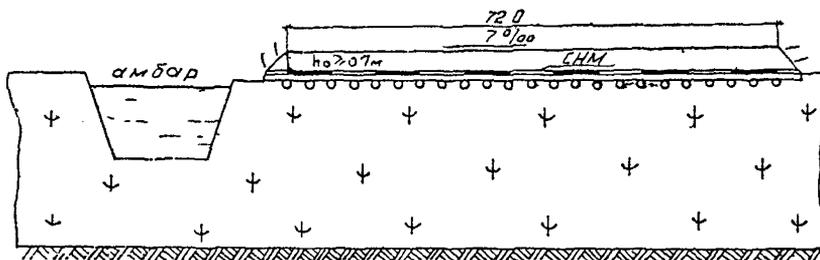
Конструкция кустового основания на болотах I—III типов при расчетной толщине насыпного слоя более 1,5 м и отсыпке насыпи из однородных песков
